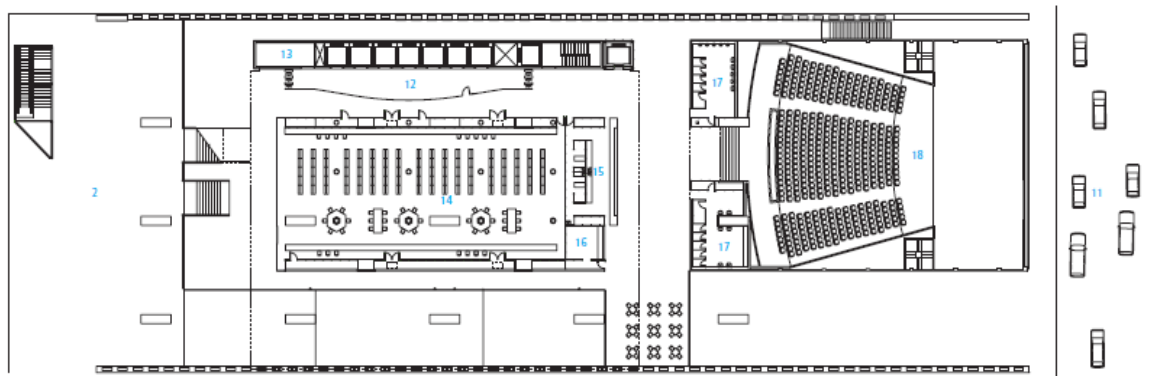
Planta arquitectónica nivel inferior de la intervención
